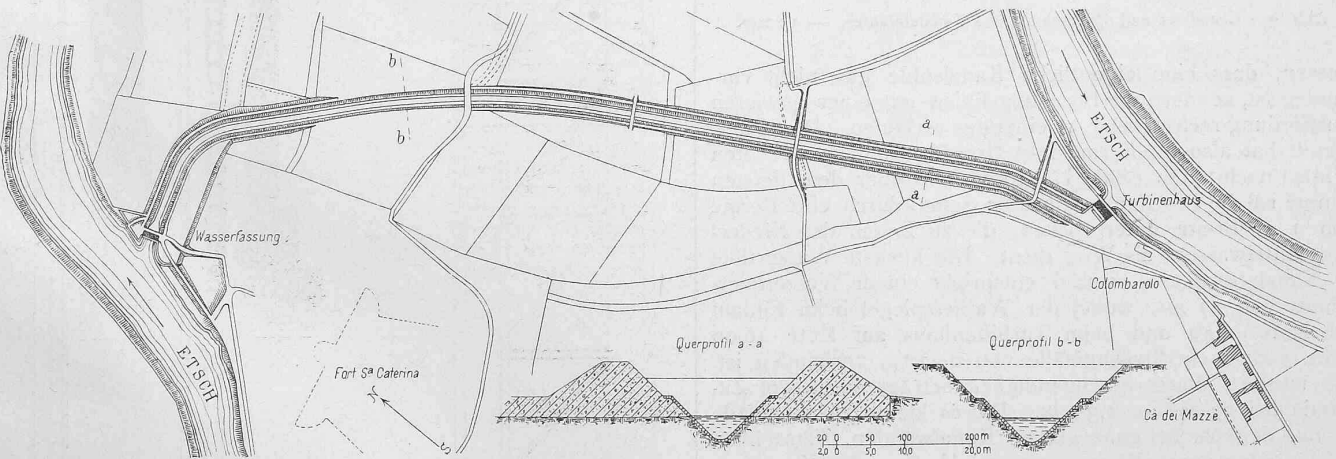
Lageplan der Anlage und Querprofile des Zulaufkanales. — Masstab 1:10000 für den Lageplan und 1:1000 für die Querprofile.
